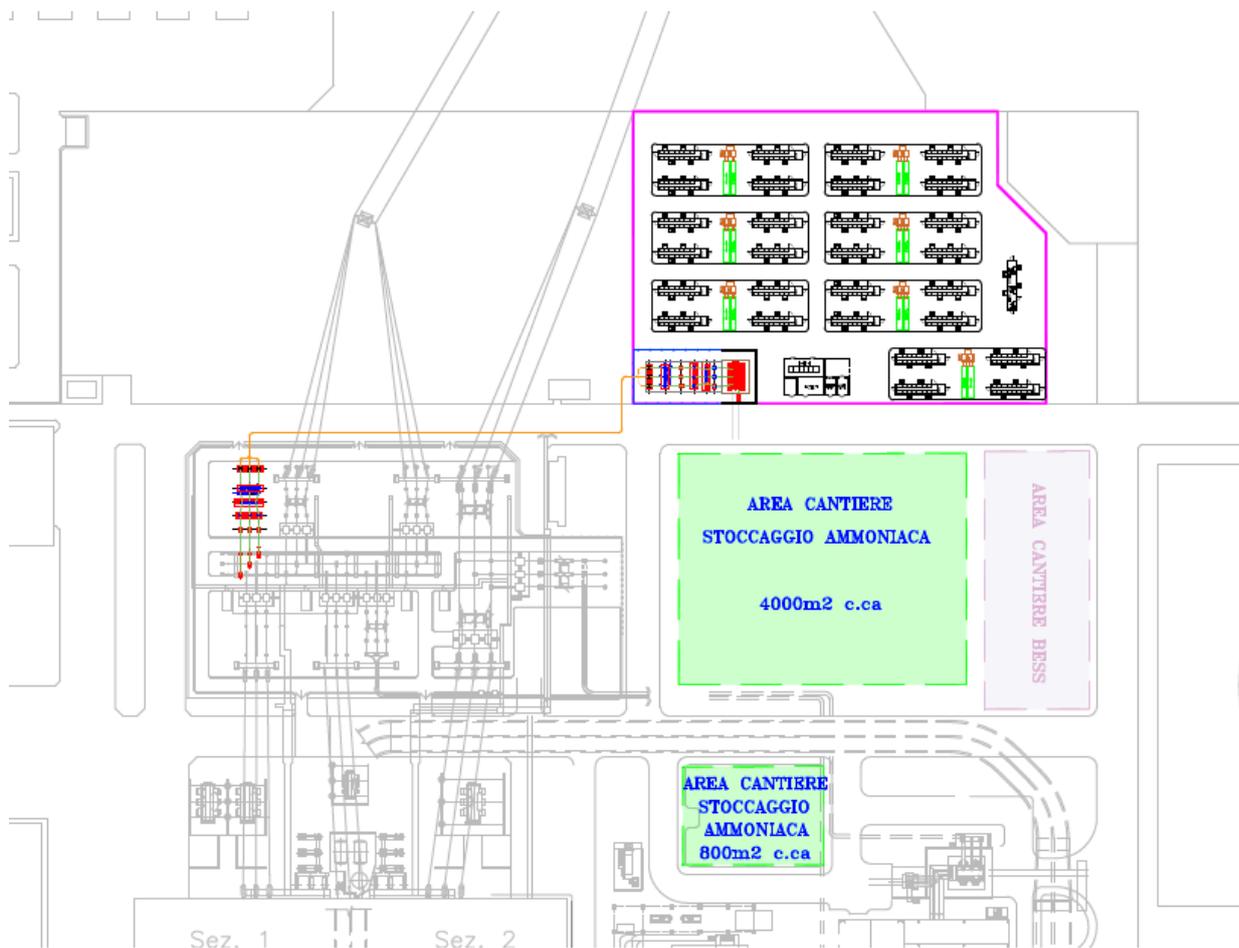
Stralcio della planimetria generale dell'area BESS
